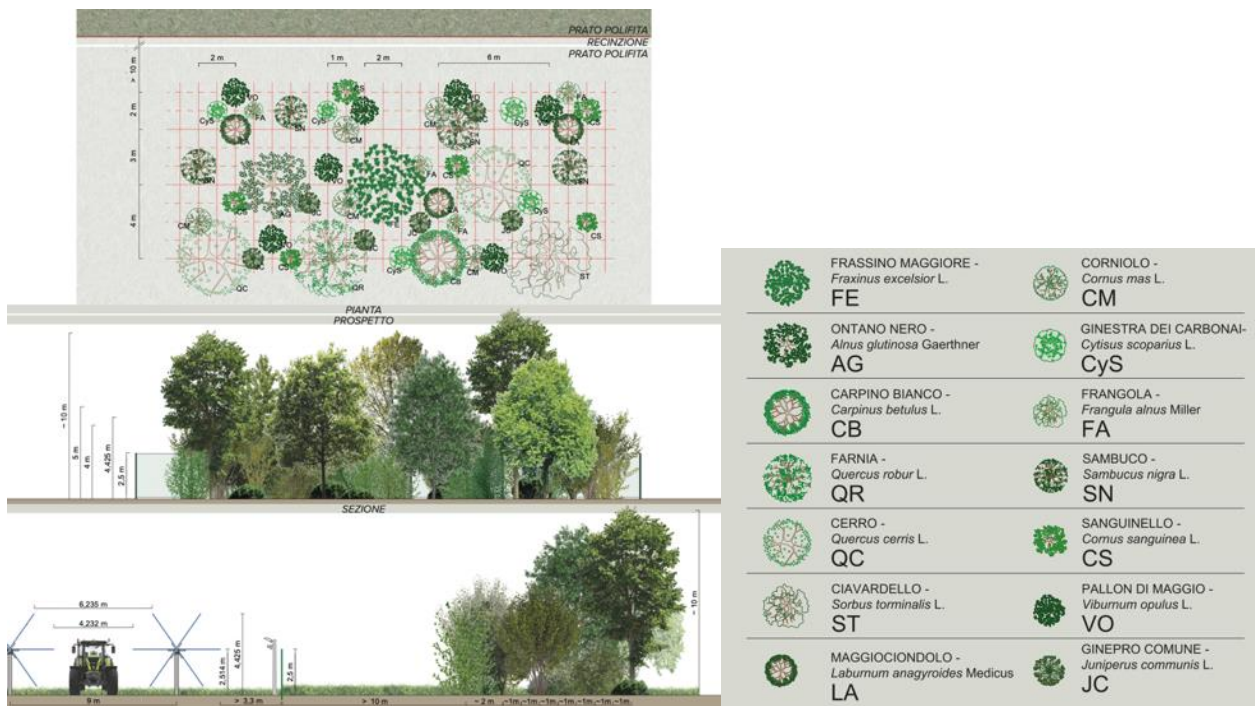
Sesto di impianto, prospetto e sezione delle fasce vegetate di Tipo 4.
